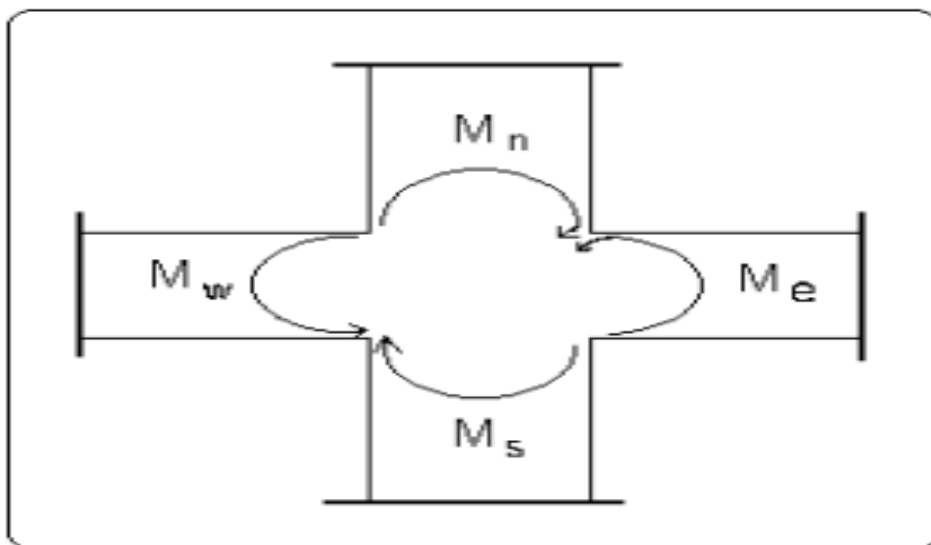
Dimensionnement d'un nœud poutre – poteau. [28]
